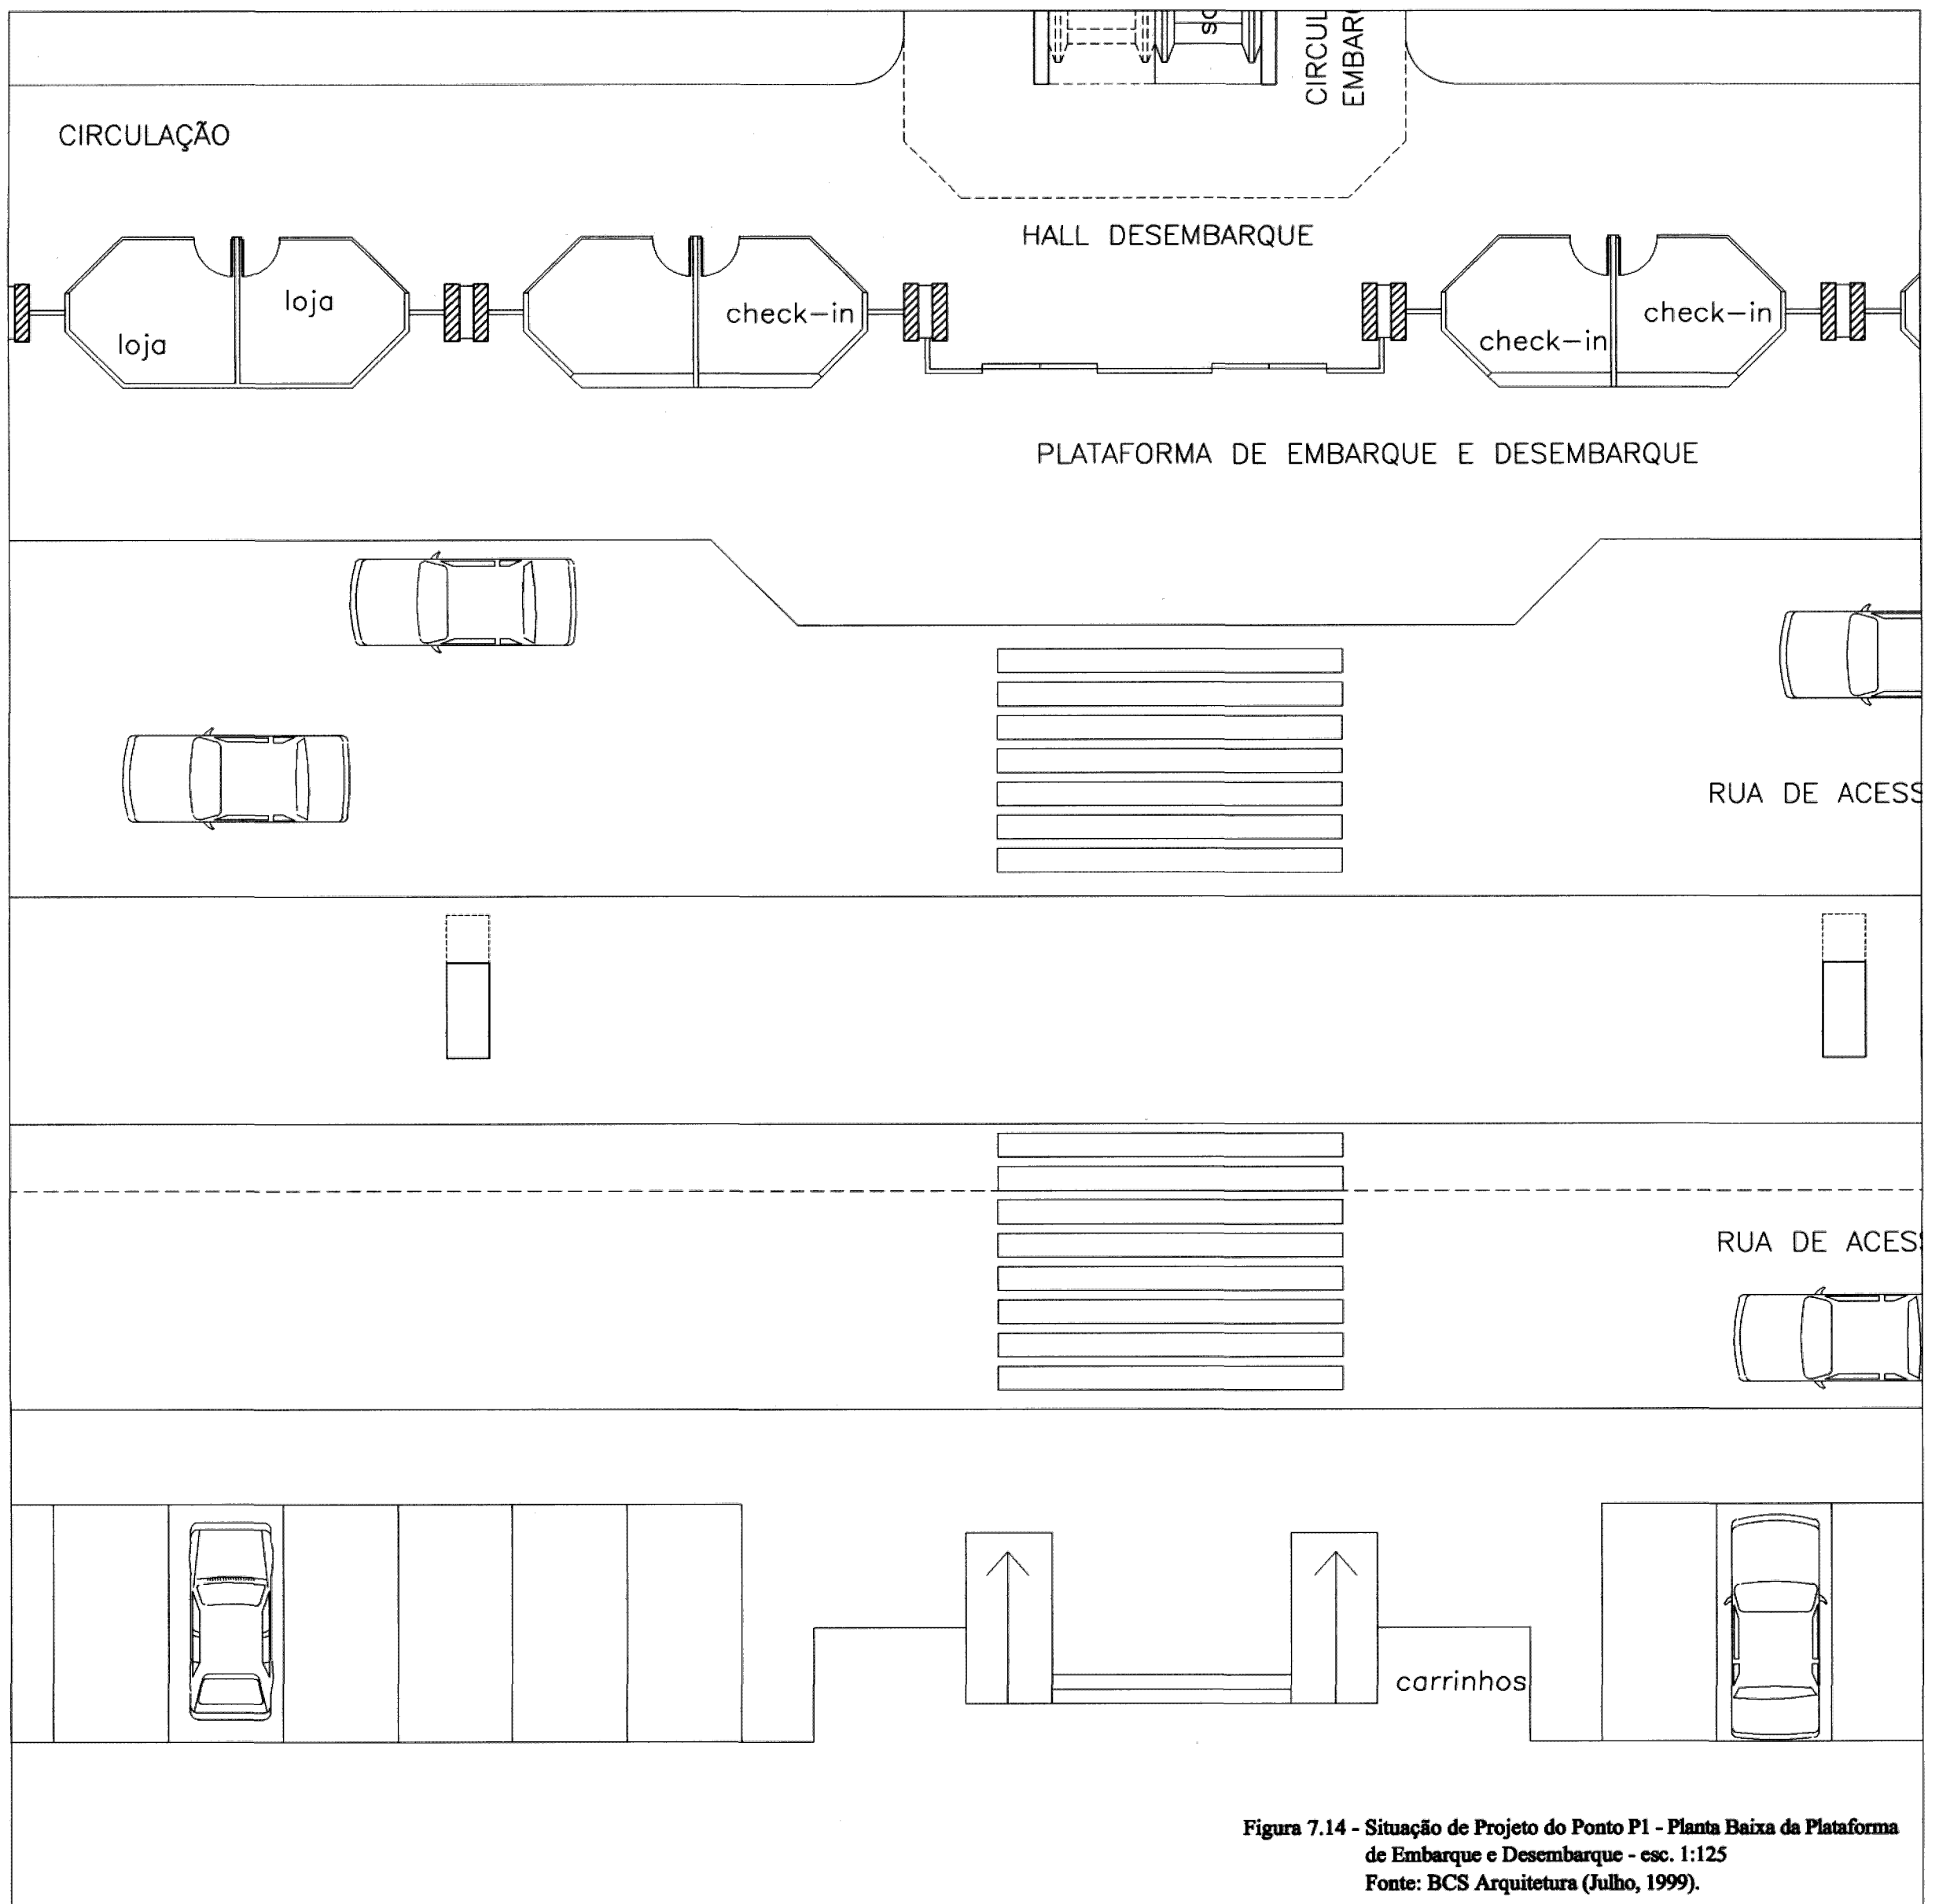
Situação de Projeto do Ponto P1 - Planta Baixa da Plataforma de Embarque e Desembarque - esc. 1:125
